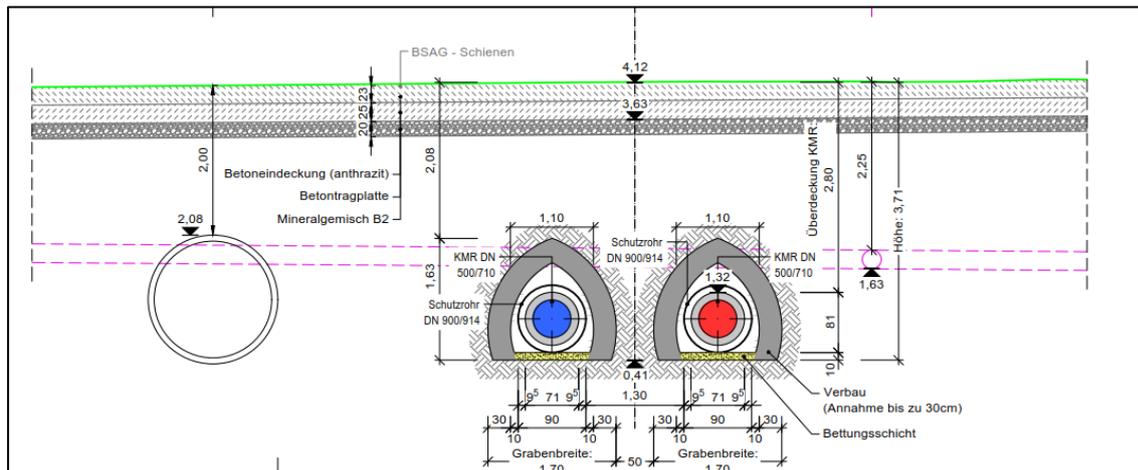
Unterquerung in Stollenbauweise: Oberbau Betonaufbau in Knotenpunkten mit Rillenschiene (59 Ri2) (Beispiel: BSAG 4)
